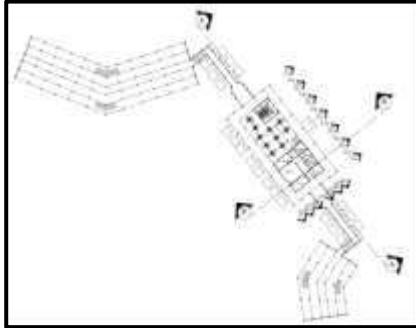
Denah Retail kerajinan tangan dan oleh-oleh
